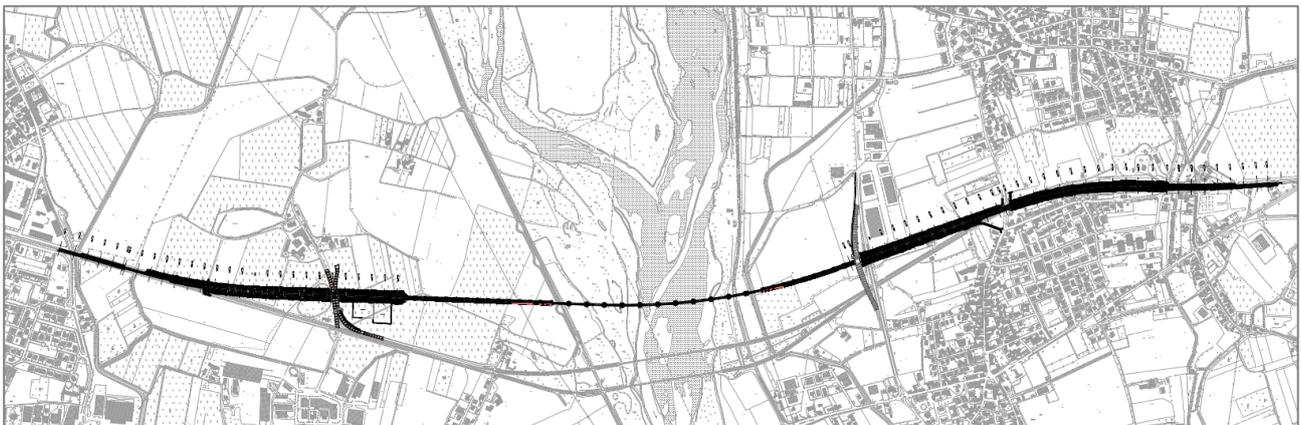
Variante Isonzo: Planimetria di progetto – Sviluppo generale
